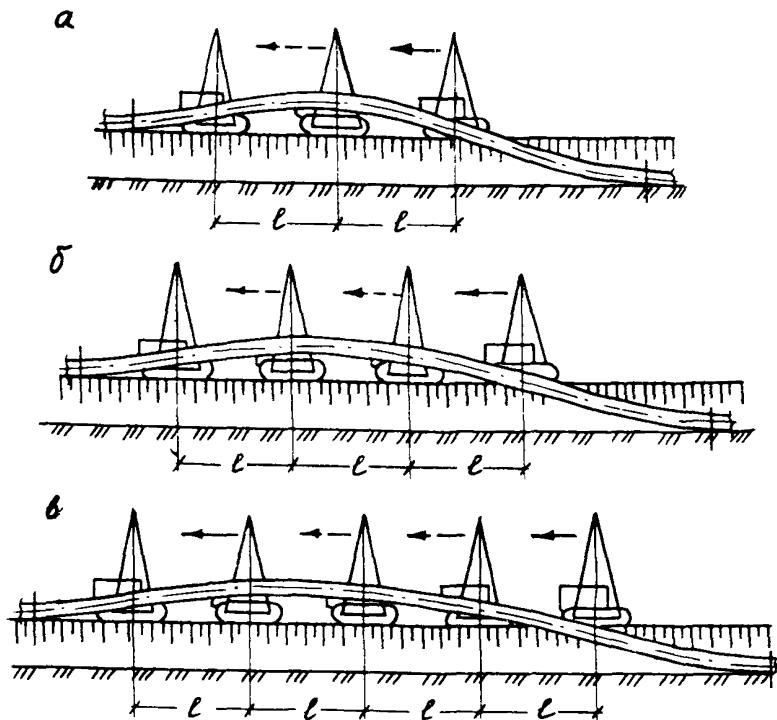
Технологические схемы укладки изолированного трубопровода цикличным методом при диаметре труб:
